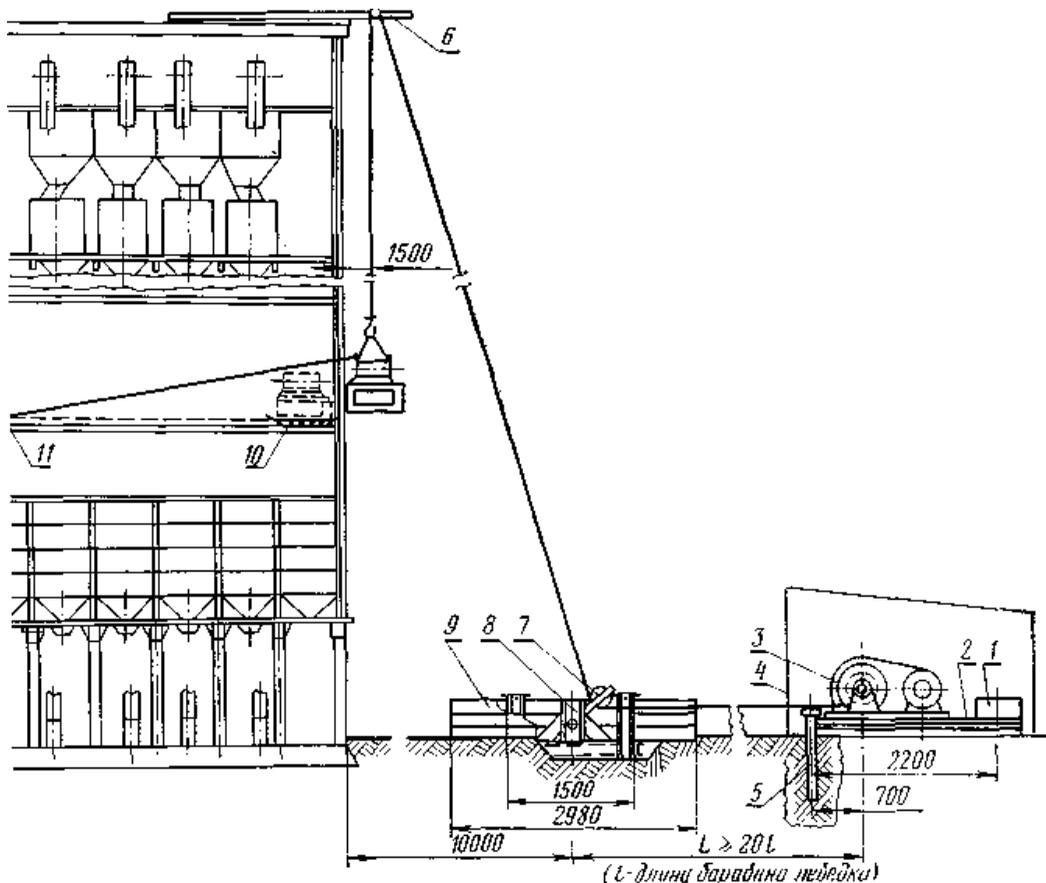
Схема подъема оборудования на этажи здания элеватора лебедкой при помощи выносной стрелы: 1 – бетонный блок противовеса лебедки; 2 – рама для установки лебедки и противовеса; 3 – электрическая лебедка; 4 – временный навес над лебедкой; 5 – свайный якорь (швеллер № 22, $l=2400$ мм); 6 – выносная стрела; 7 – однорольный блок (отводной); 8 – рама для якоря отводного блока; 9 – якорь отводного блока из бетонных плит массой 10 т; 10 – инвентарные поддон и катки; 11 – лебедка рычажная для оттяжки и горизонтального перемещения оборудования
